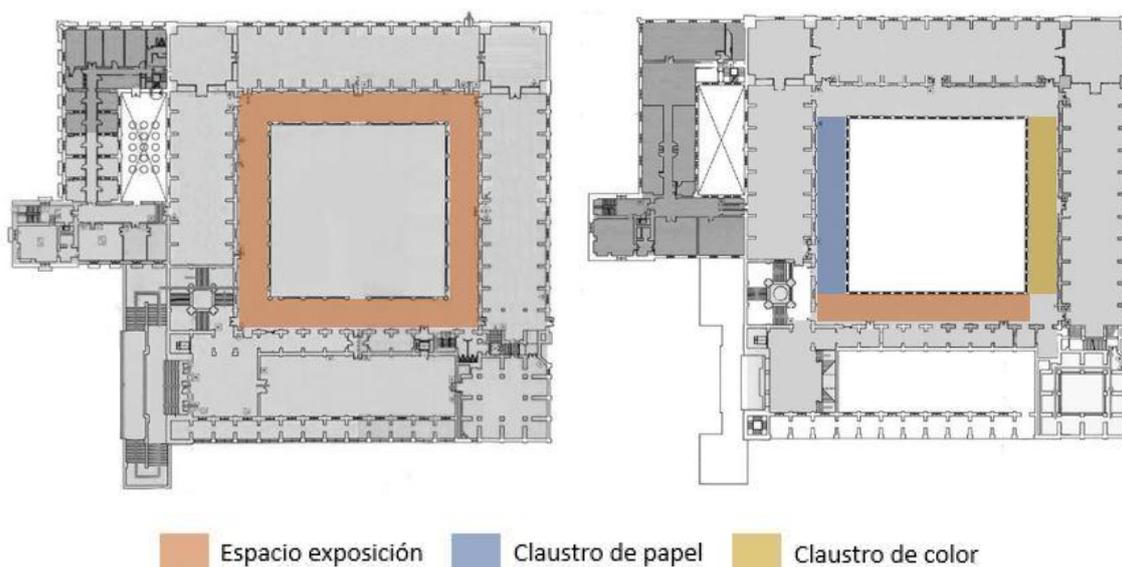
Planos de la primera y segunda planta del museo y zonas destinadas al proyecto expositivo.
